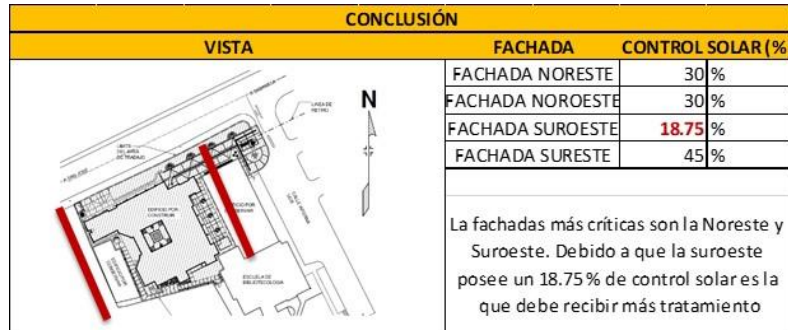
Fachada más crítica del edificio de Tecnologías en Salud, según la orientación del proyecto. (El Autor)
